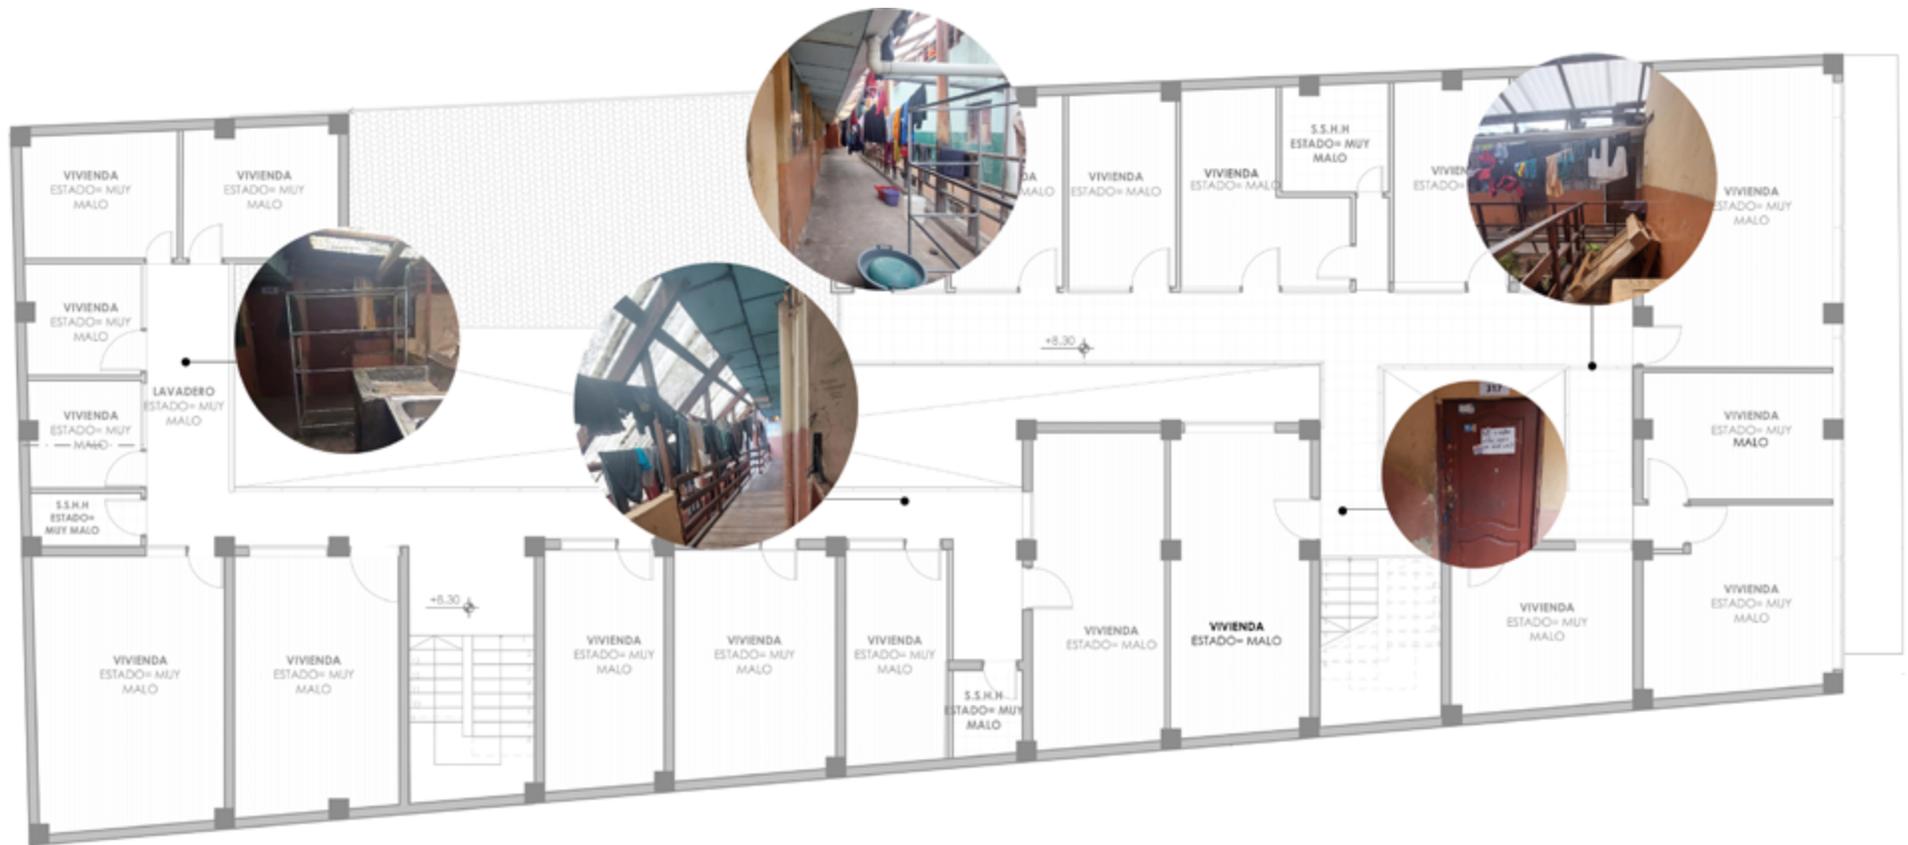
Vistas al rededor de la tercera planta alta. Autoría propia [Fotografía e ilustración].
